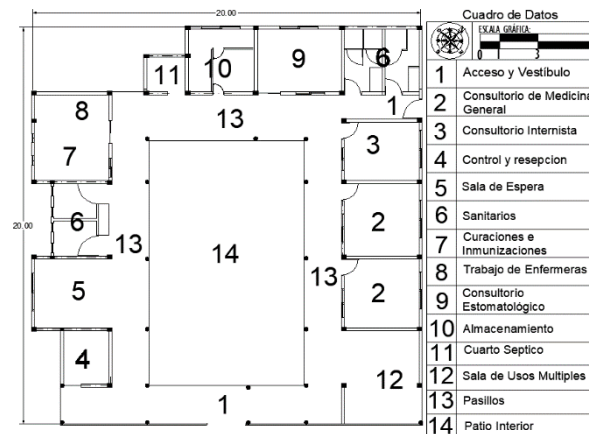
Planta arquitectónica del Centro de Salud Rural con listado de espacios
